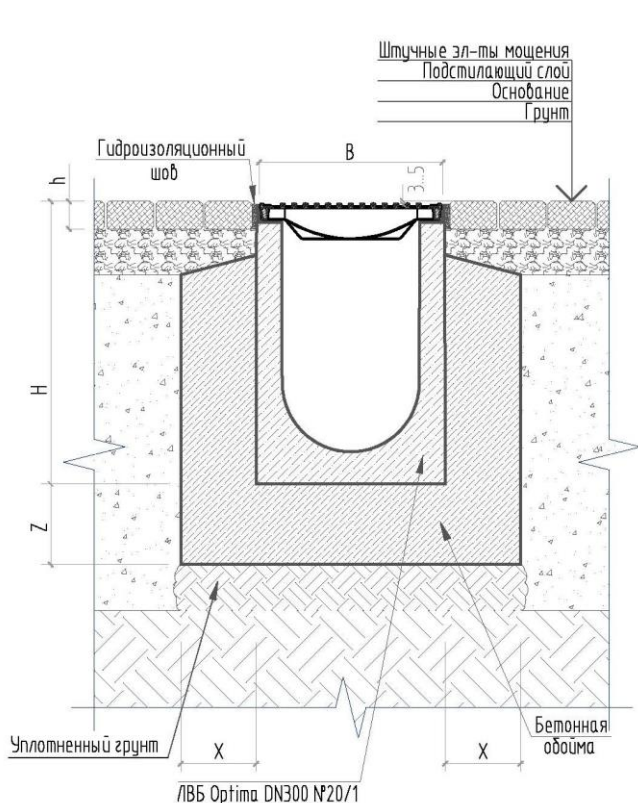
а – Устройство упрощенной бетонной обоймы лотка с штучными элементами мощения для классов нагрузки от А15 до В125.
